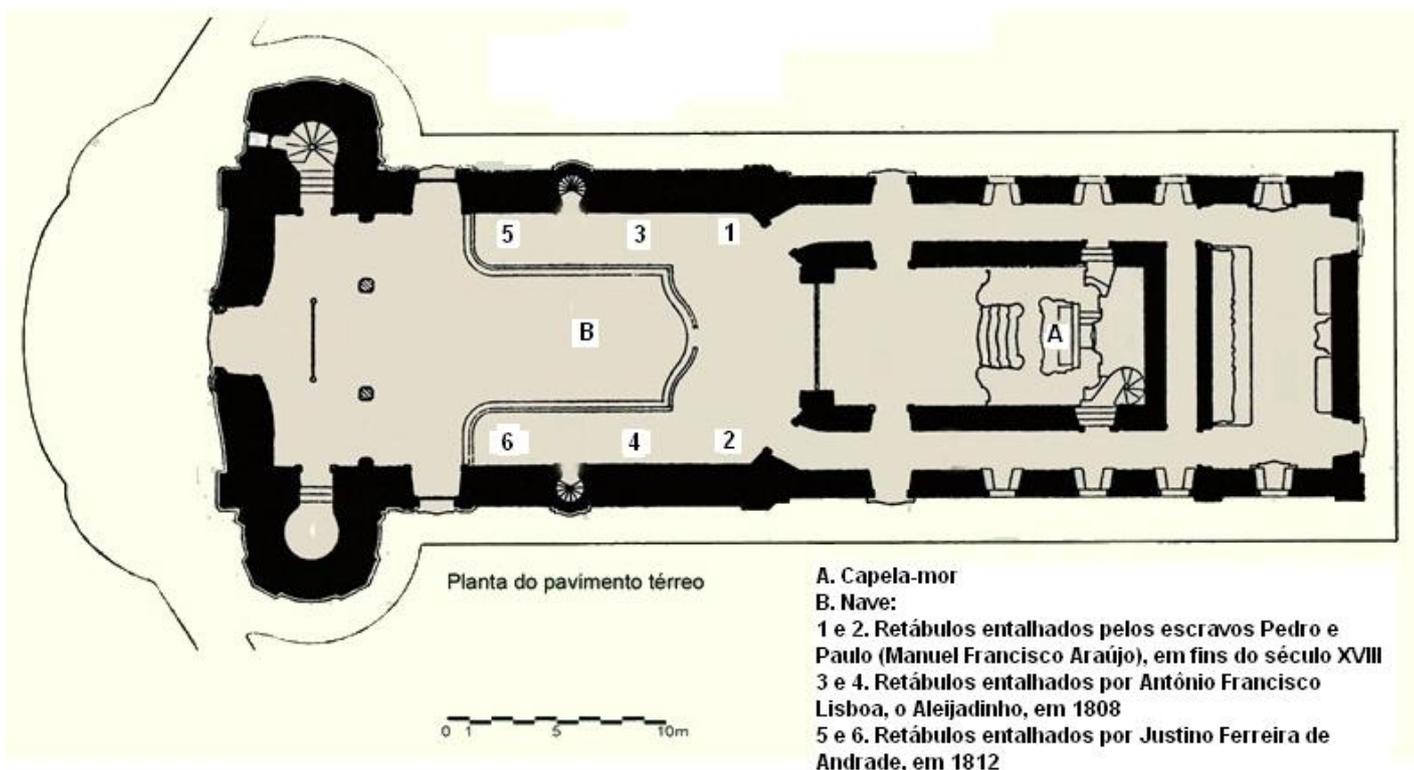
Planta baixa da Igreja da Ordem Terceira de N. Sra. do Carmo de Ouro Preto
